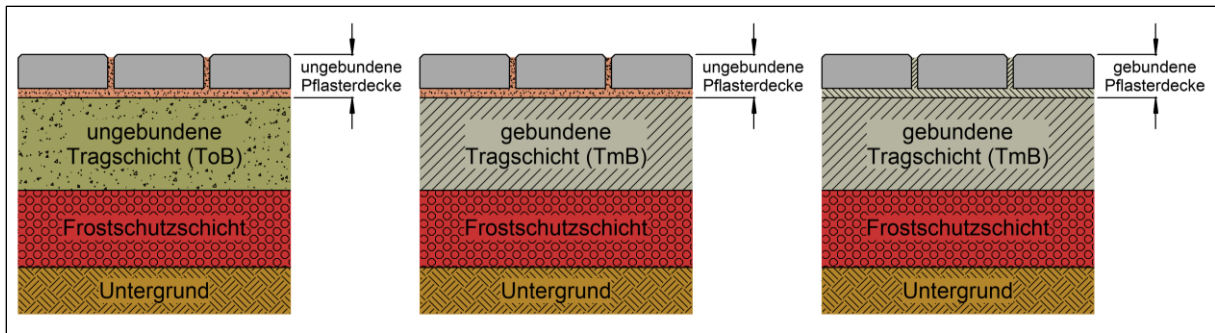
Klassische Oberbaukonstruktionen im Straßenbau mit ungebundener oder gebundener Ausführung der Pflasterdecke (Zeichnung: SLG)
